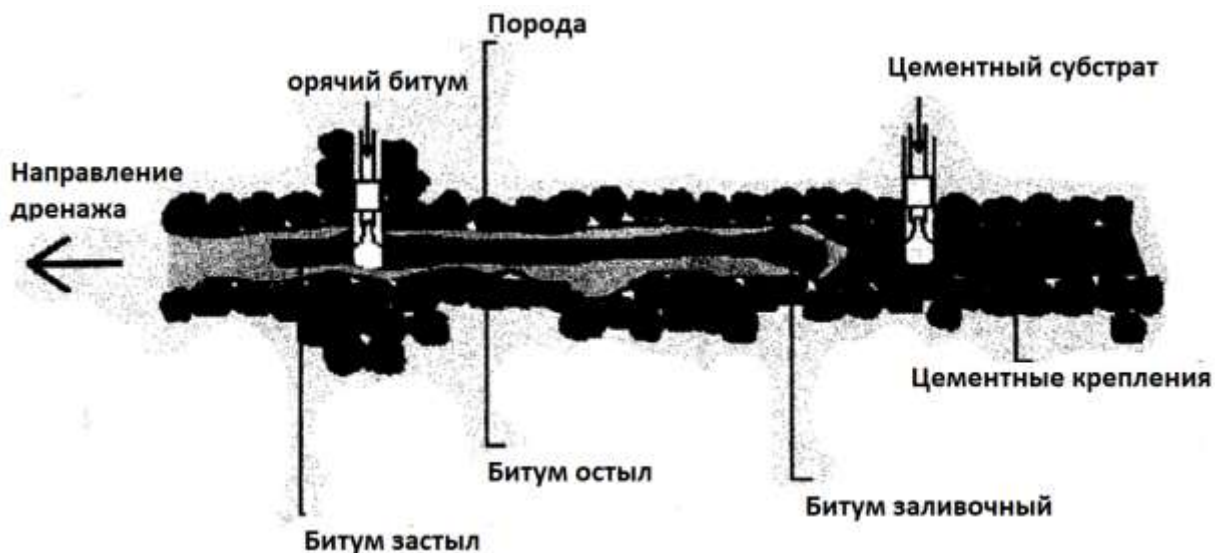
Принципиальная схема укрепления грунта и породы жидким битумом
